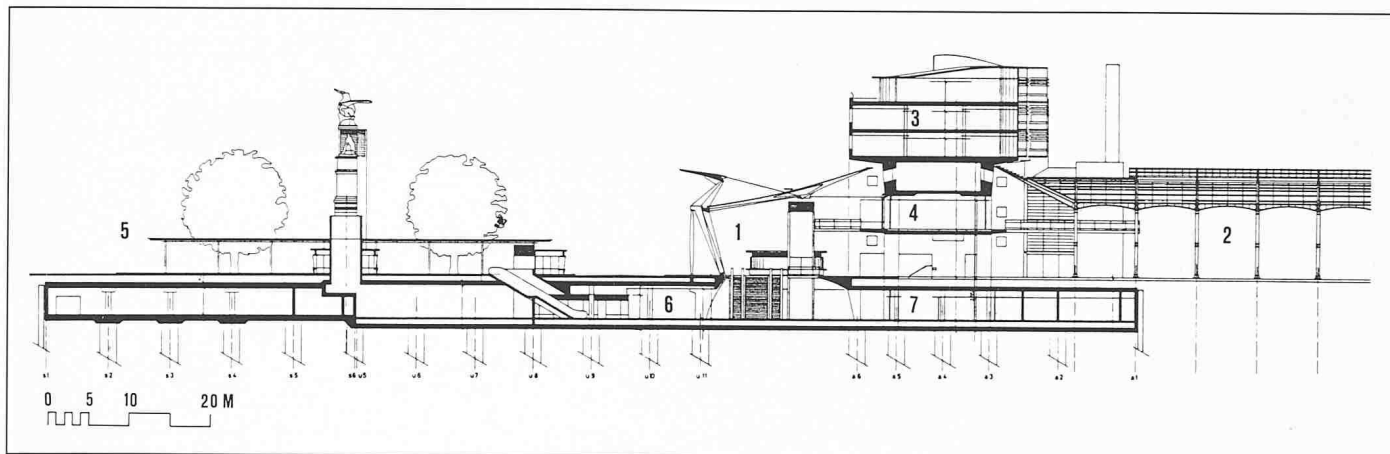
Schnitt Nord-Süd: 1 Bahnhofvorhalle, 2 Perronhalle, 3 Obergeschoss für Fremdnutzung, 4 Restauration, 5 Bahnhofplatz, 6 Fussgängerunterführung und Läden, 7 Kundendienst SBB
